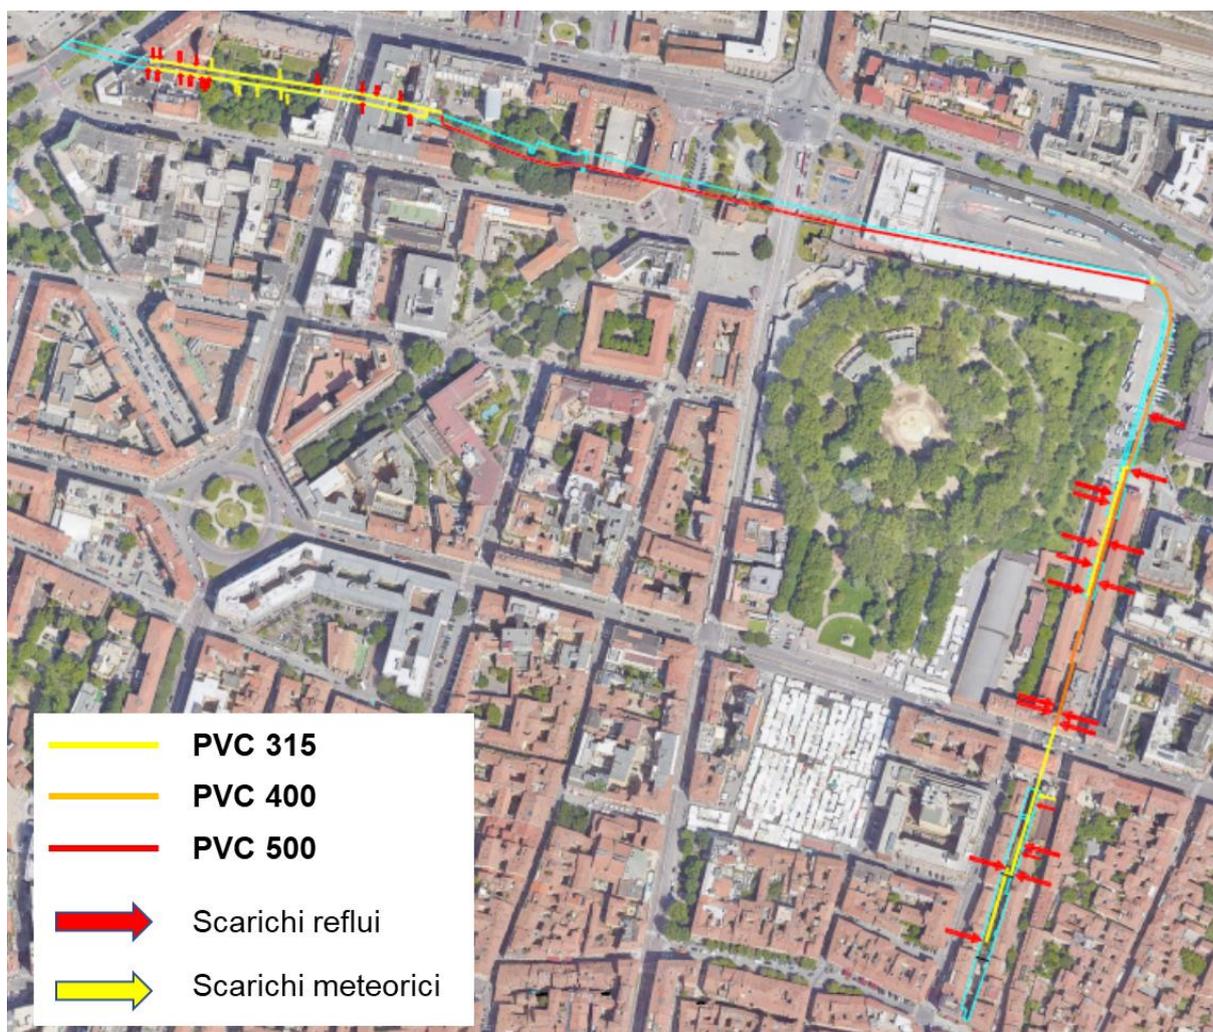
Inquadramento planimetrico su base ortofoto dei nuovi collettori fognari previsti e della posizione degli scarichi censiti
